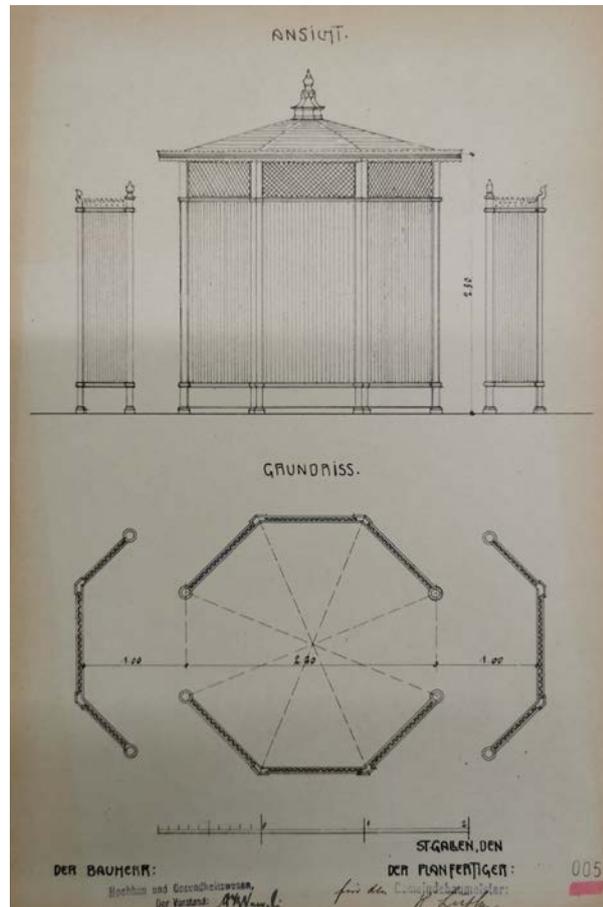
Ansicht und Grundriss eines Pissoir-Häuschens bei der Unterstation St. Leonhard, Geltenwilenstrasse 2, Hermann Lüthy, ca. 1915, Baudok.
